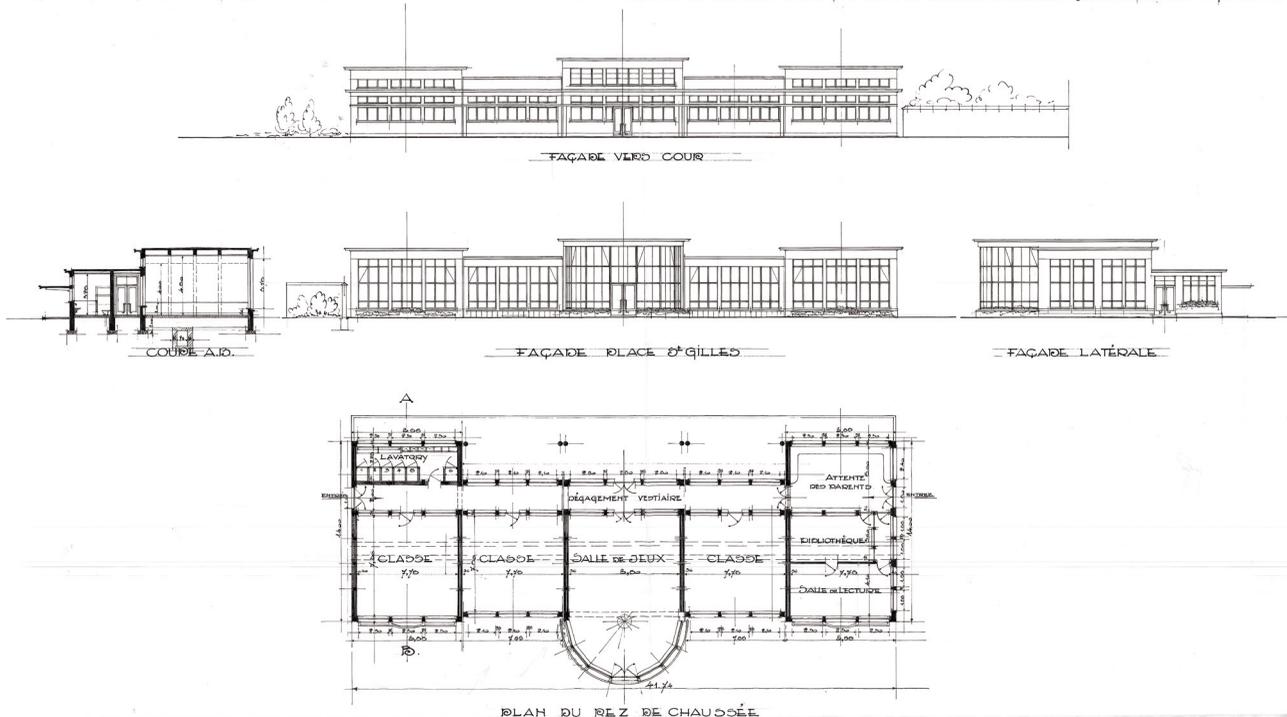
Jean Moutschen, plan et élévations de la façade avant du bâtiment à rue de l'école communale André Bensberg.
